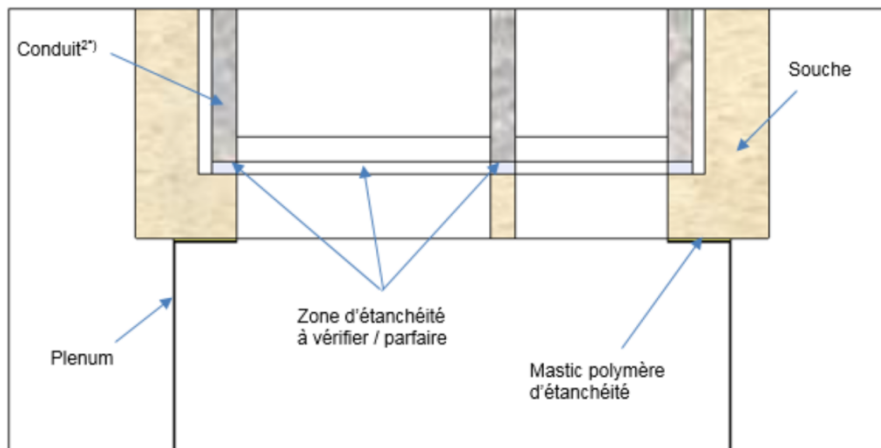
Coupe horizontale d'un plenum en piquage sur souche
